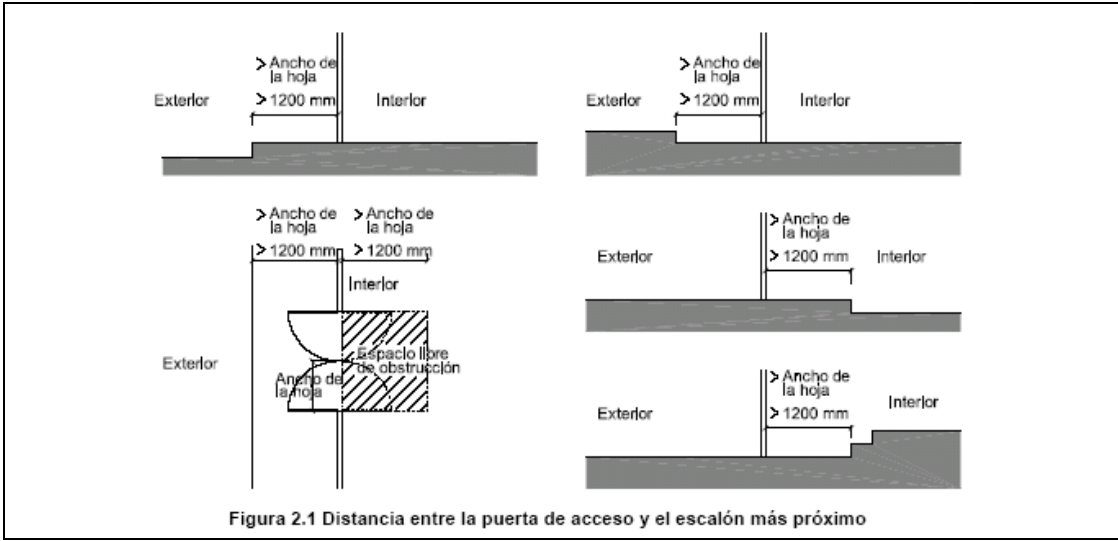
Distancia entre la puerta de acceso y el escalón más próximo
